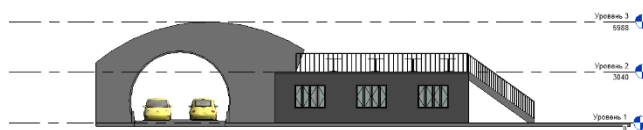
Архитектурно-планировочное решение (фасад - южный)
